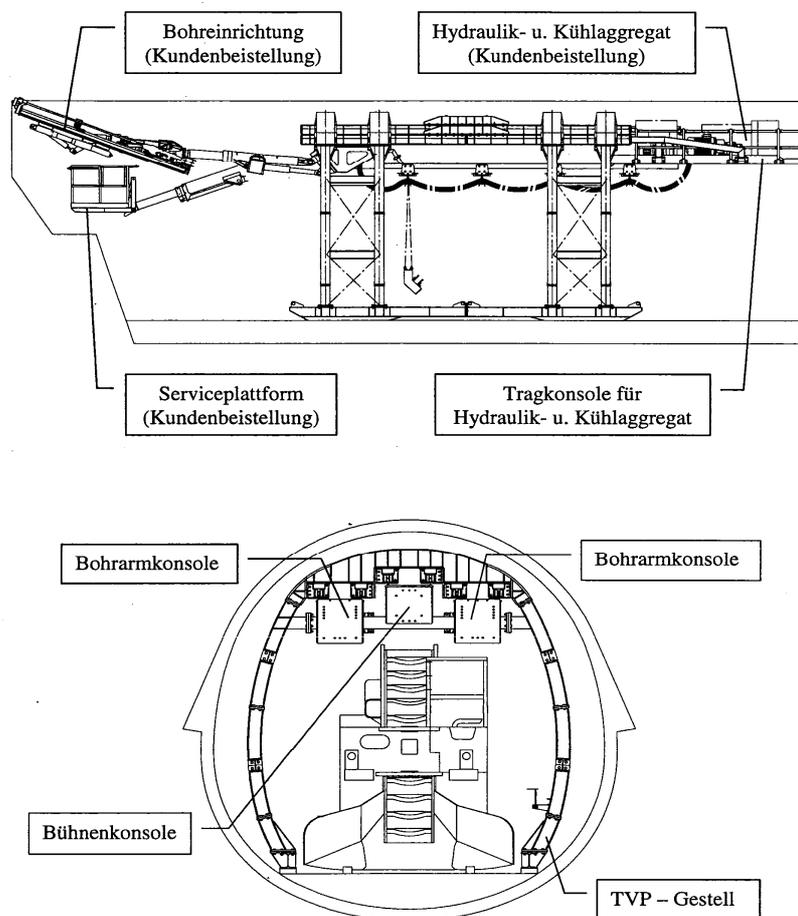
Aufbau des Tunnelvortriebsportal [17]
